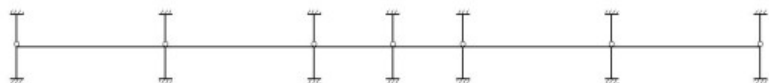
Расчетная схема плоской рамы с шарнирным соединением колонн и диска перекрытия.
